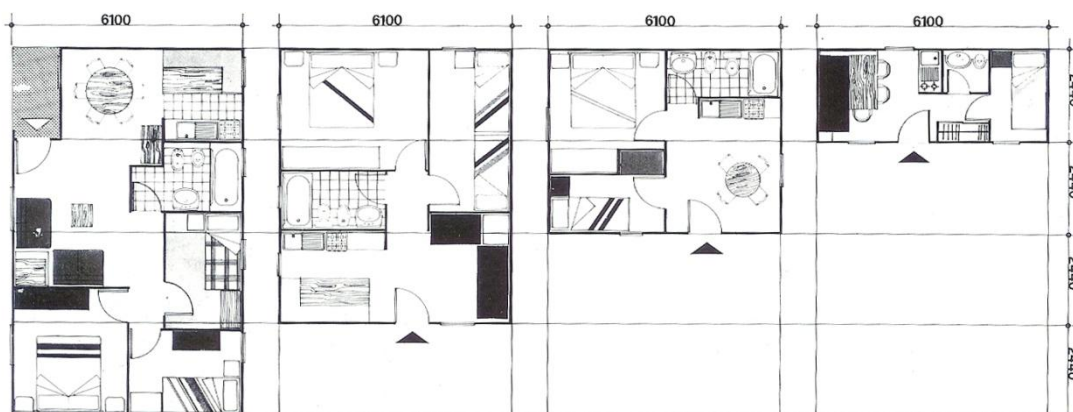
Diverse combinazioni di pianta del modulo del sistema Sage.
